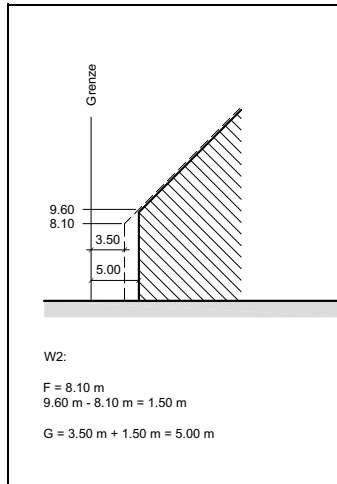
Grenzabstand eines abgerundeten Baukörpers (§§ 21–26 ABV)
